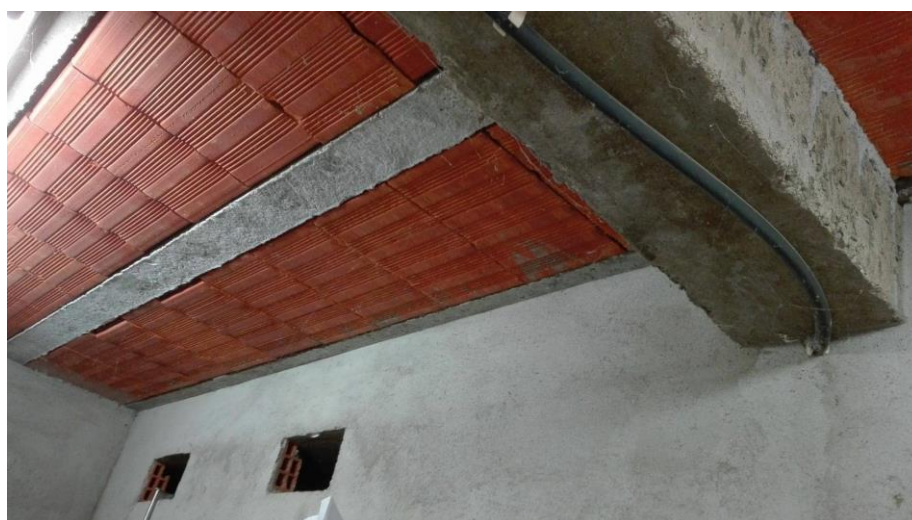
Laje aligeirada da casa apoiada em viga de betão armado
